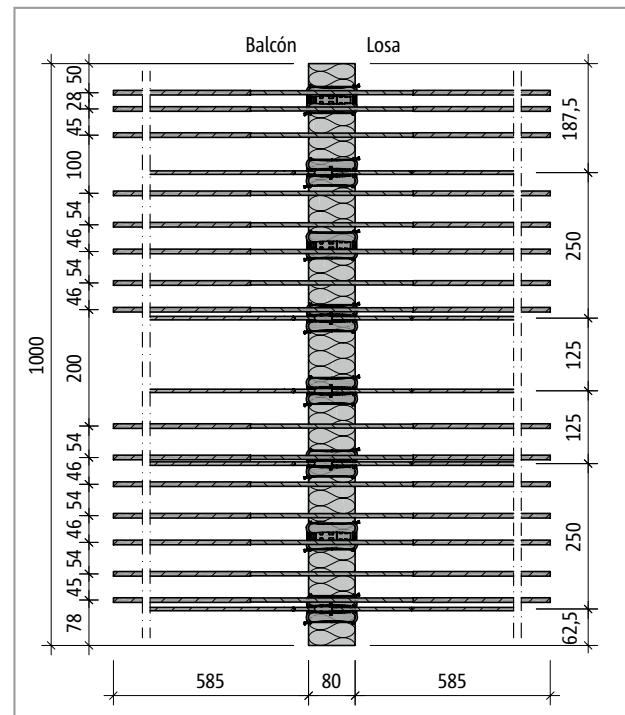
Schöck Isokorb® T tipo K-M6-V1: Plano del producto
